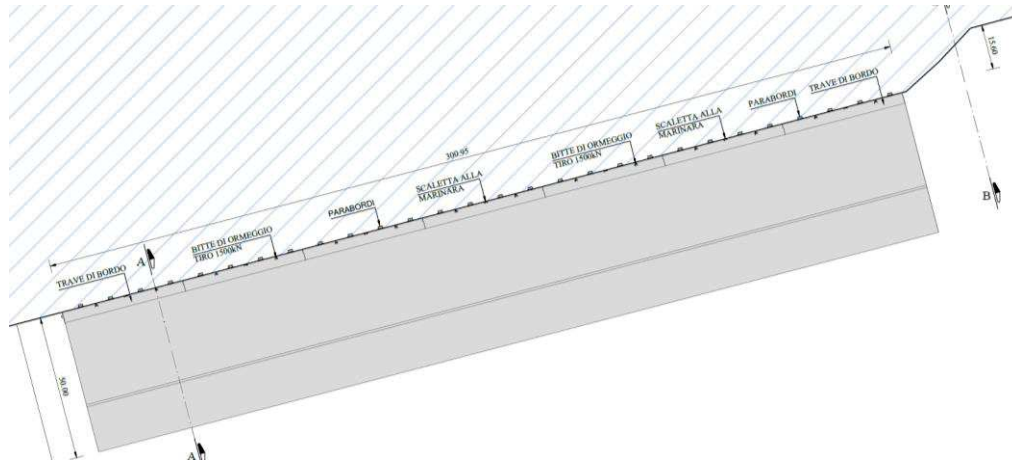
Estratto da elaborato del PD - 1114.STR.10.02 - Stato Attuale Planimetria e Sezioni_Rev.2
